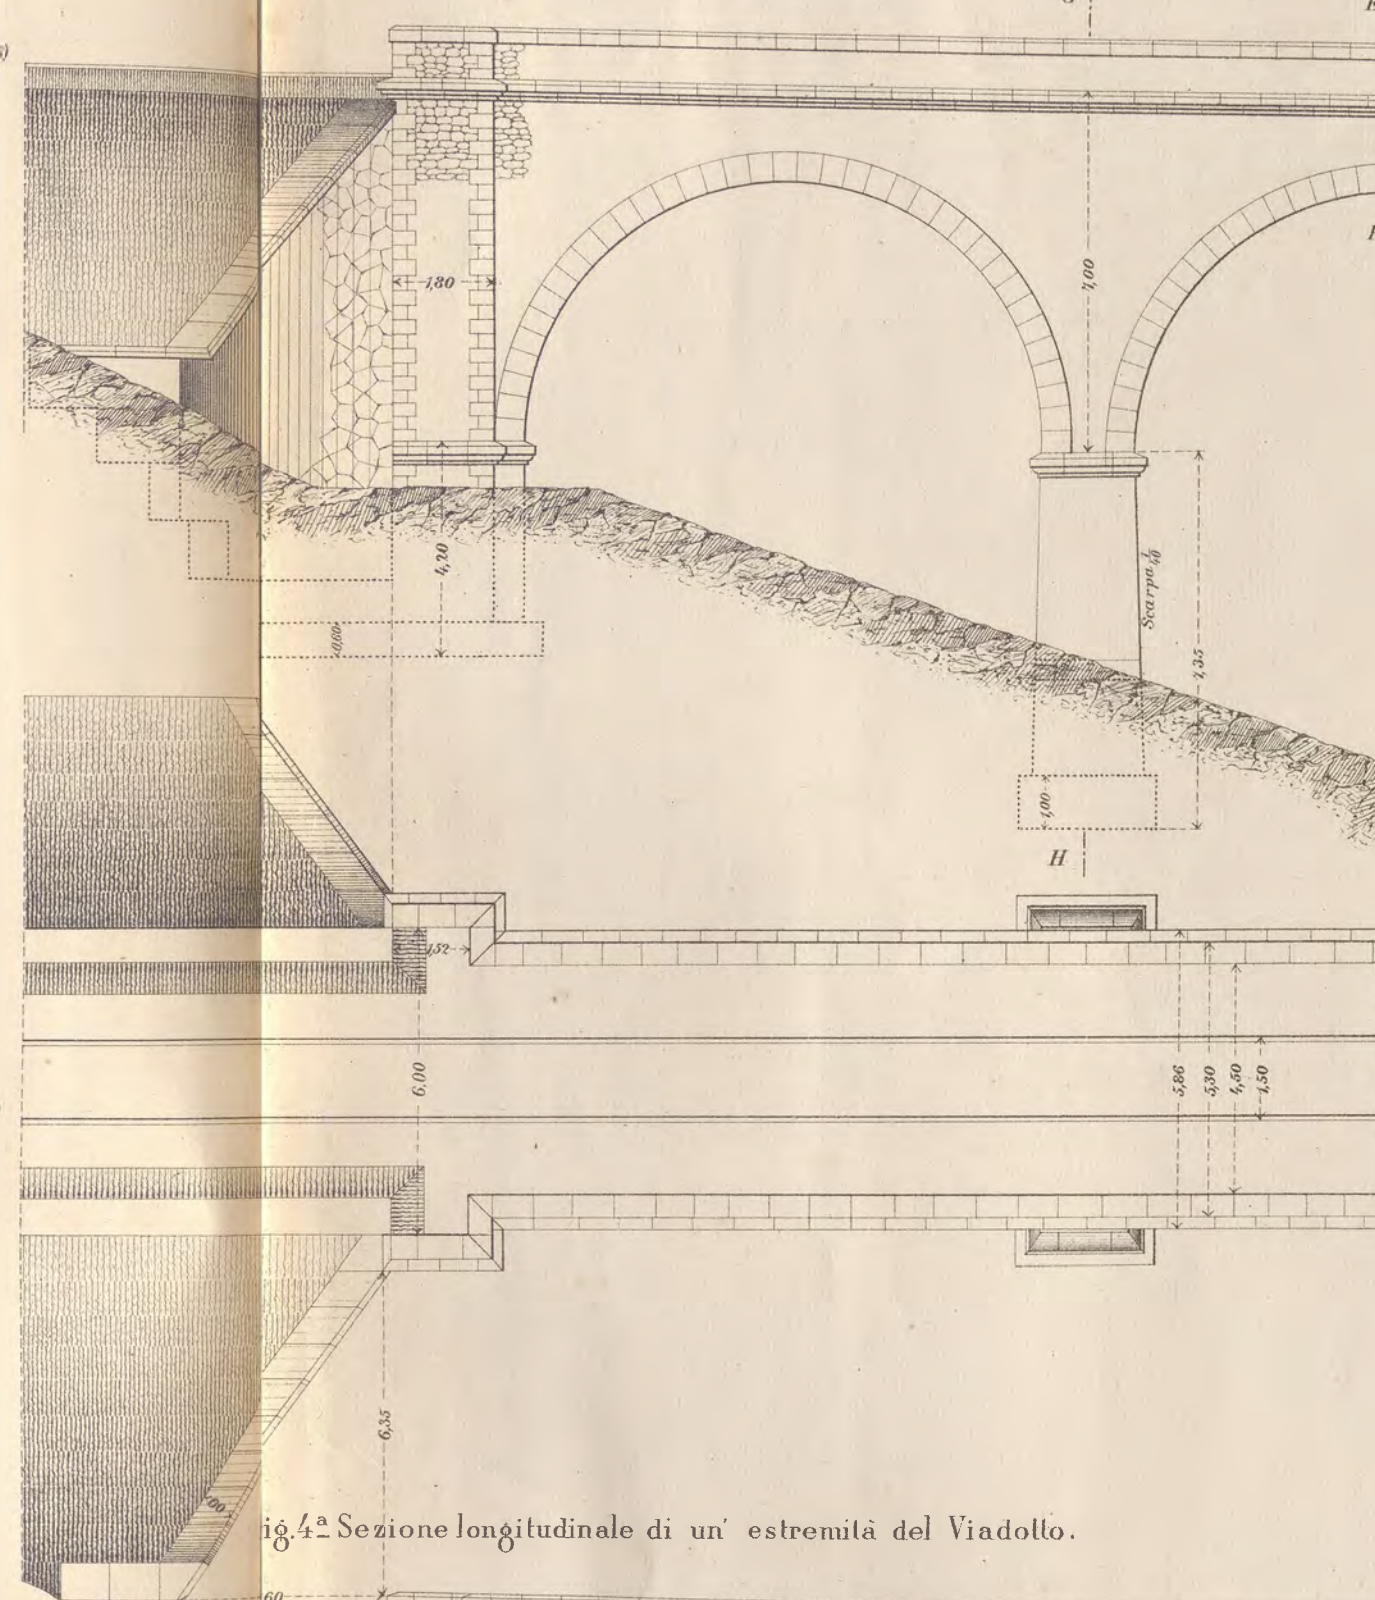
<sup>a</sup> Sezione longitudinale di un' estremità del Viadotto.
